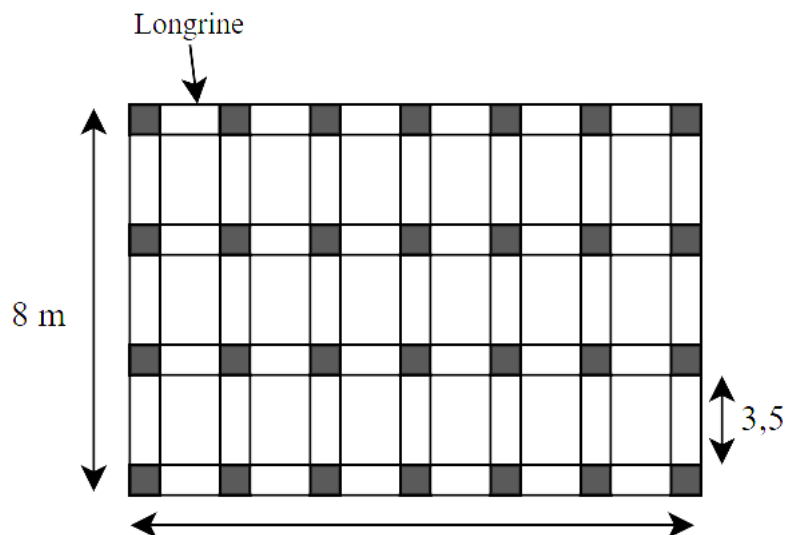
Disposition des poteaux dans la station de pompage.
